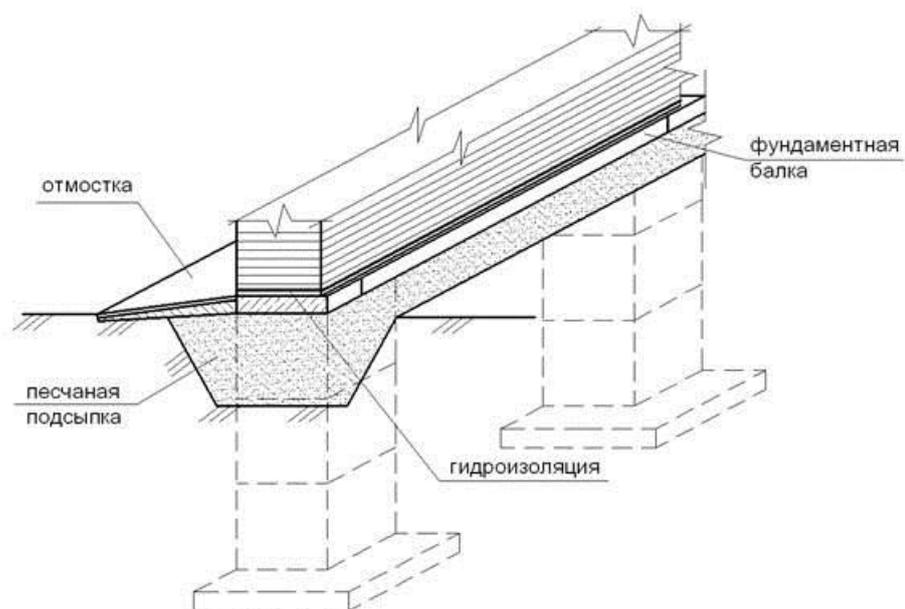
Фундамент под отдельно стоящие колонны, монолитный фундамент
